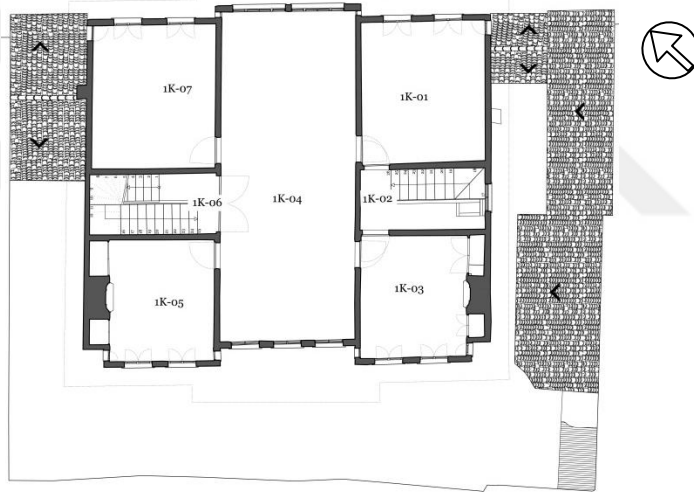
Damar Konağı Vaziyet Planı [265, 271]
